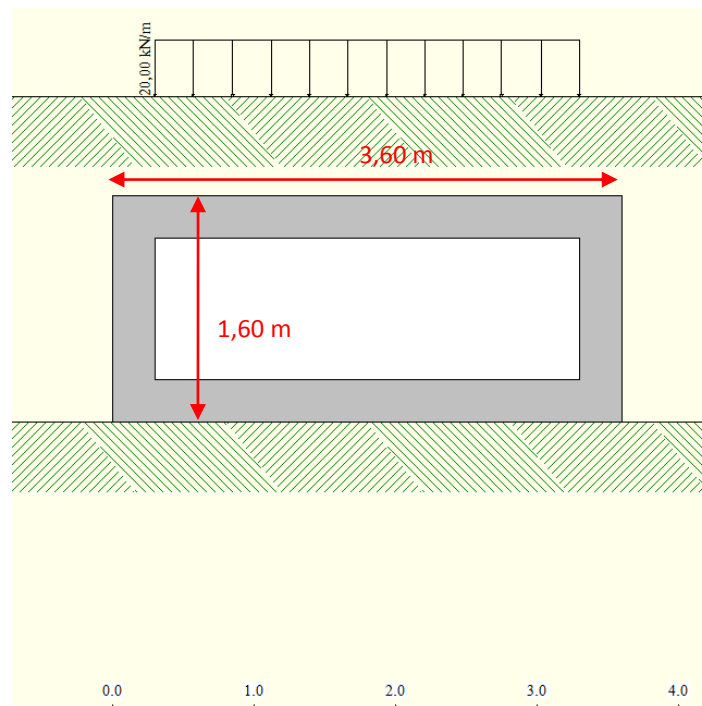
Schematizzazione della sezione di calcolo Pozzetto sbocco
